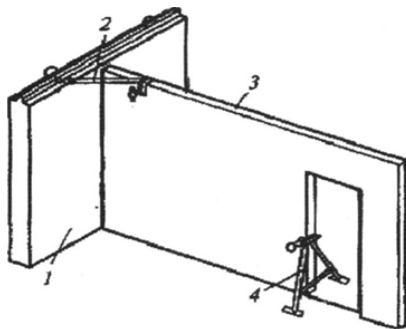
Схема временного крепления панели внутренней стены с помощью монтажной связи и монтажной опоры:
